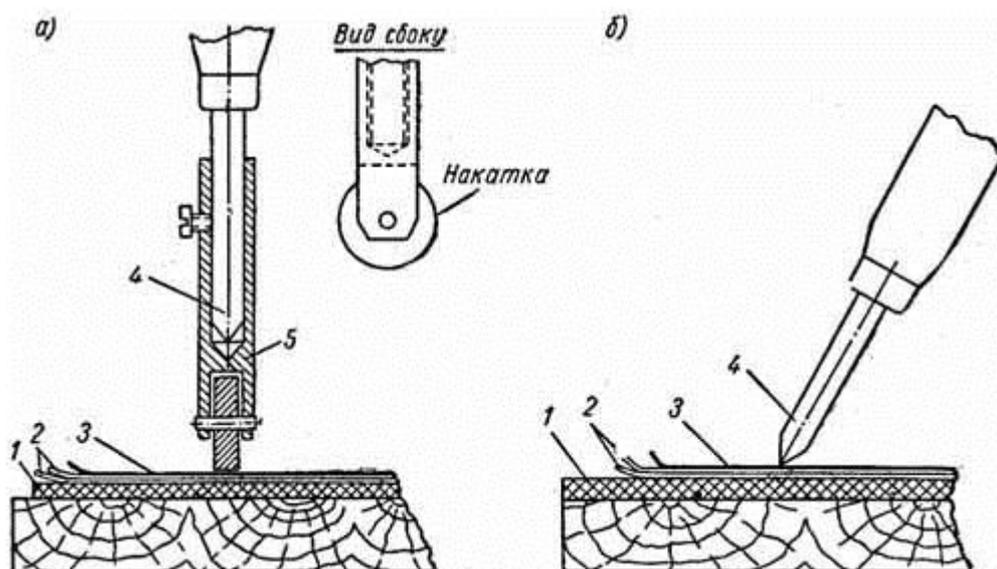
Сварка полиэтиленовой пленки:
